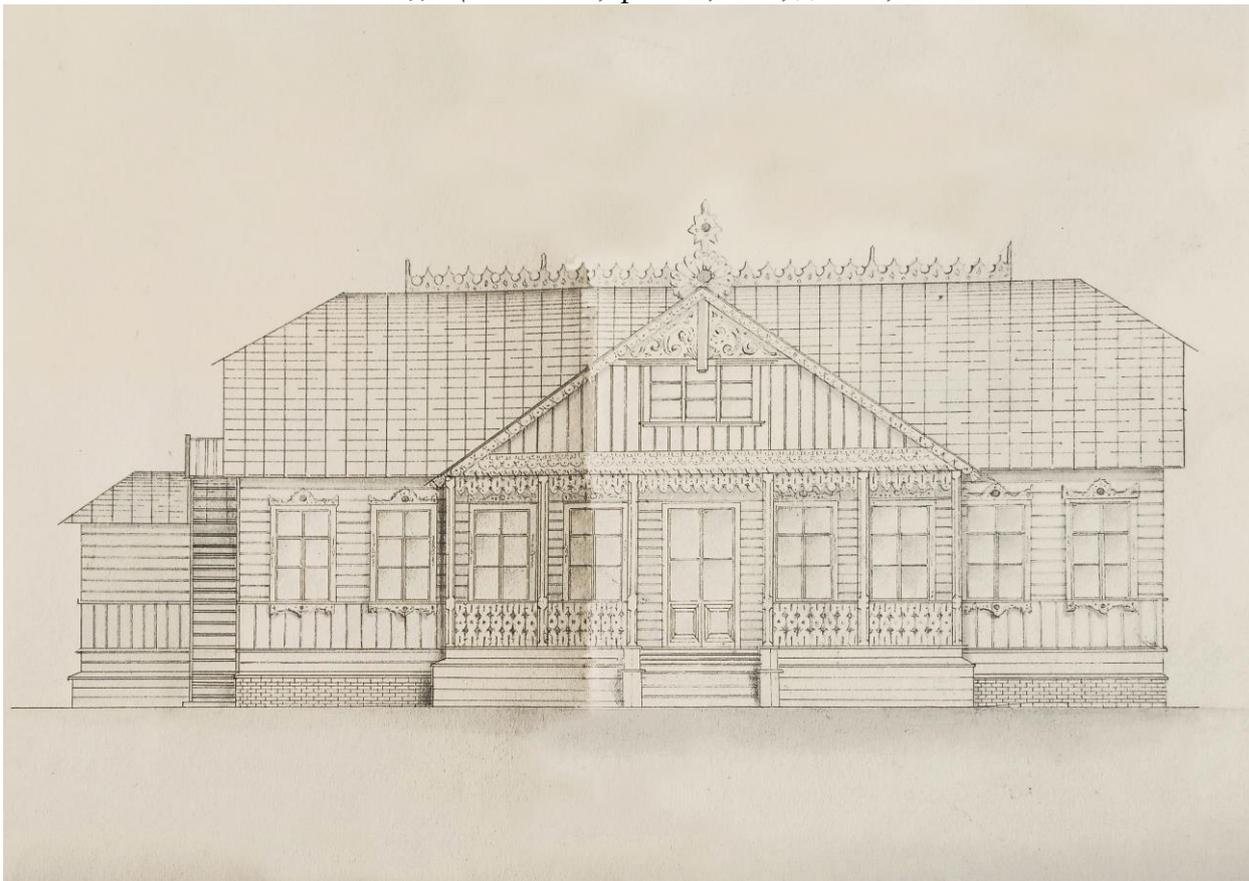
Фасад дома Михаила Николаевича Леонтьева по Железнодорожной ул., д. 23
